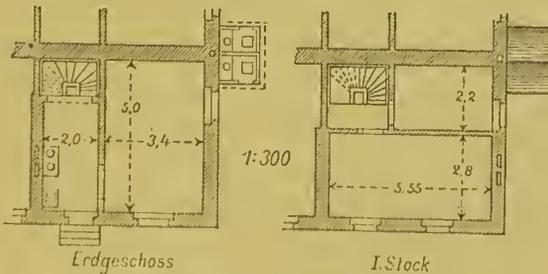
Grundriß der Mülhäuser Vierhäuser.
